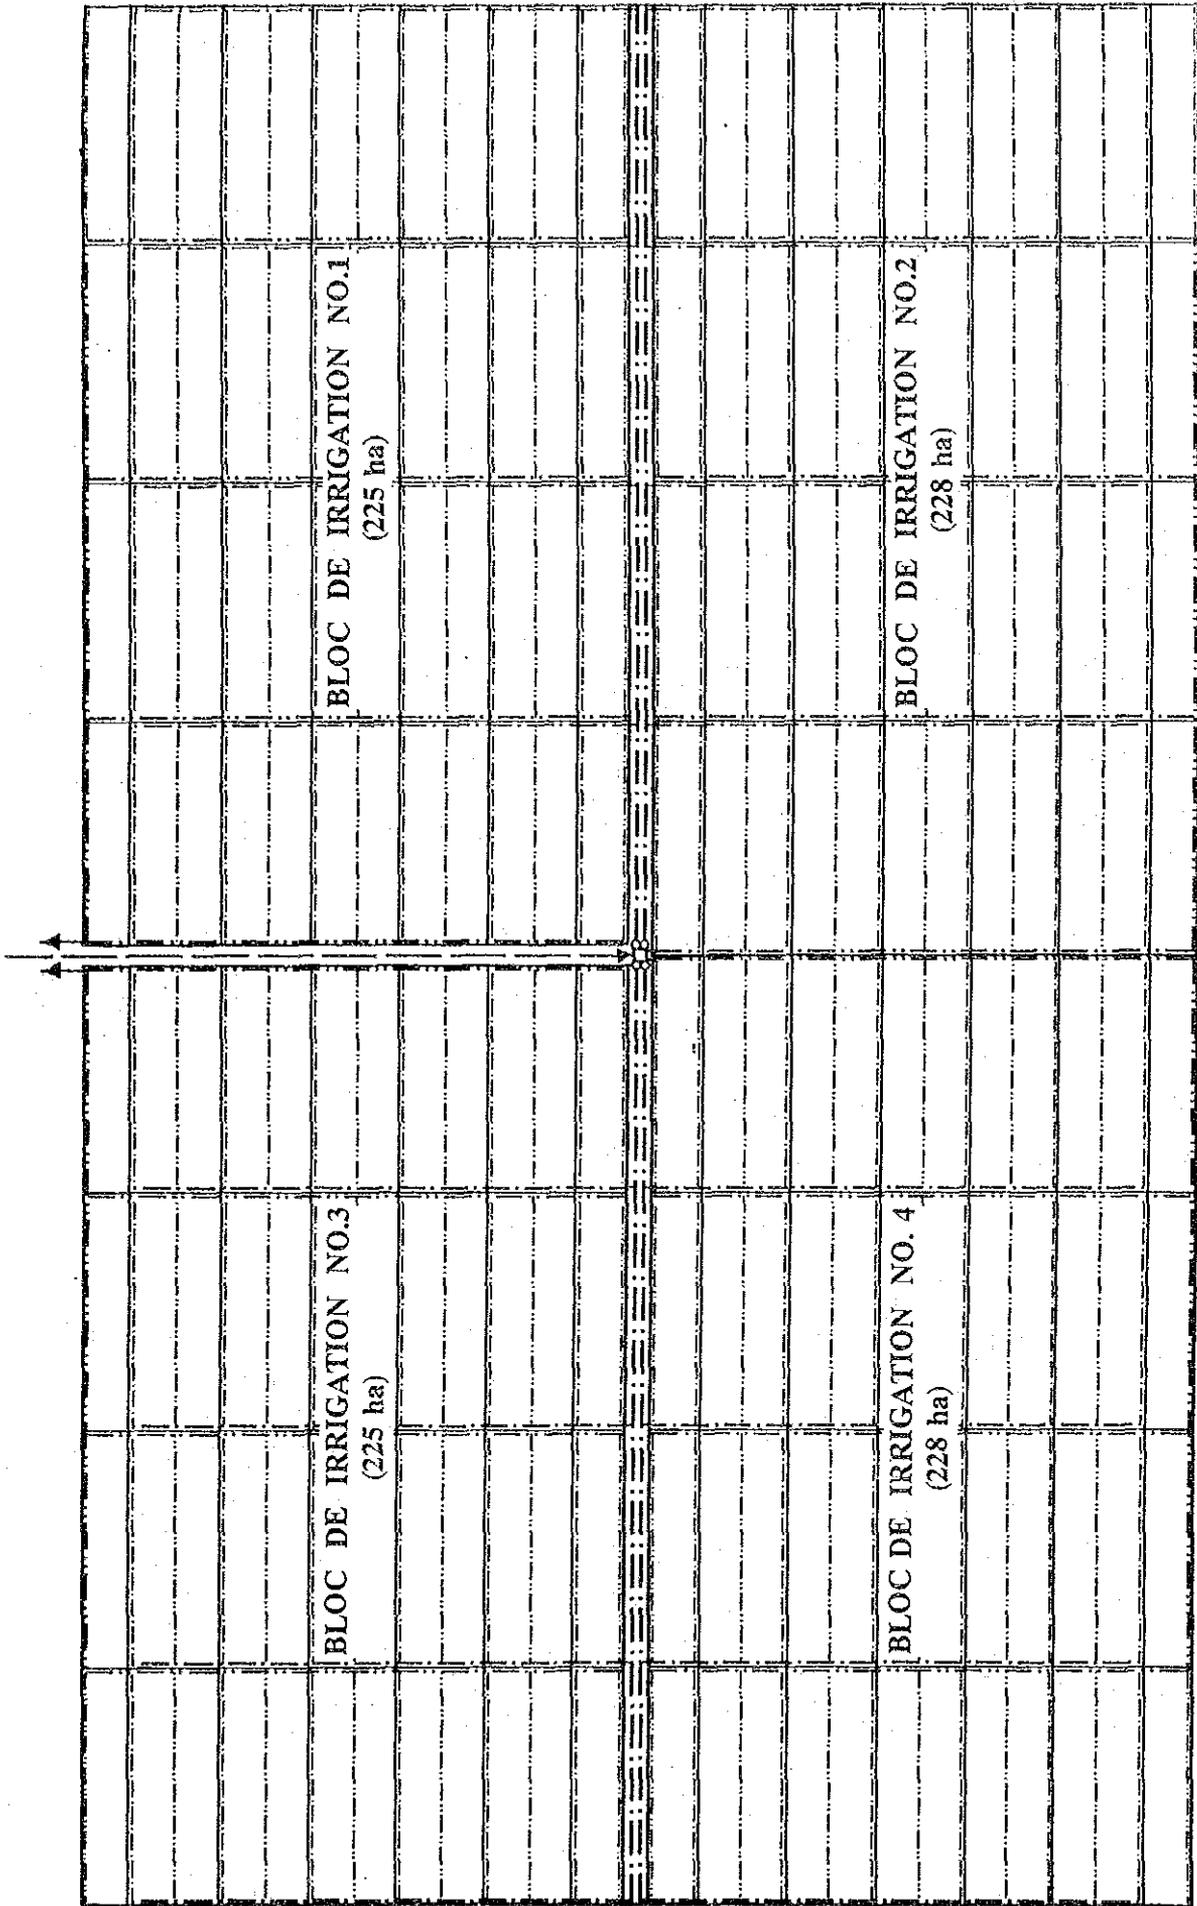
LE PLAN DE LA DISPOSITION DES PERIMETRES
